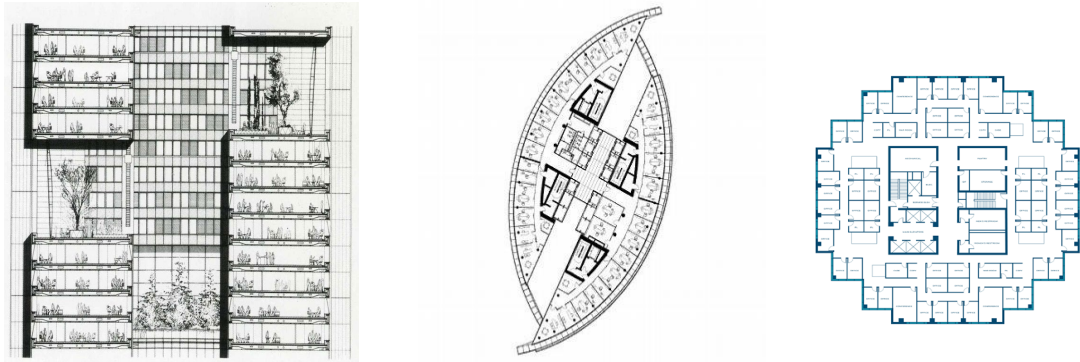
а) Commerzbank Tower, загальний вигляд плану у структурі навколишньої забудови);
